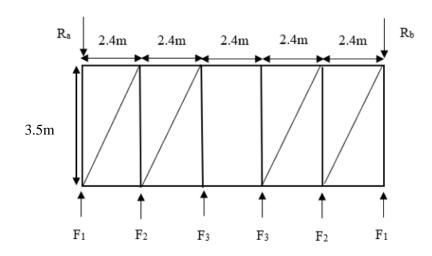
Schéma statique de la poutre au vent de pignon arrière
